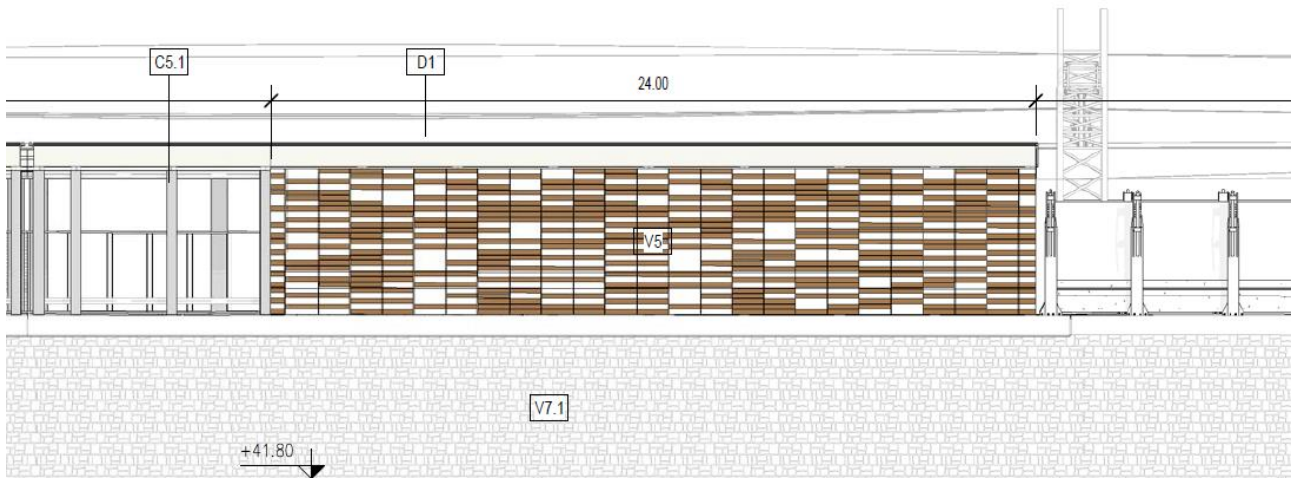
FV04 - Pensilina FV - prospetto retrostante
